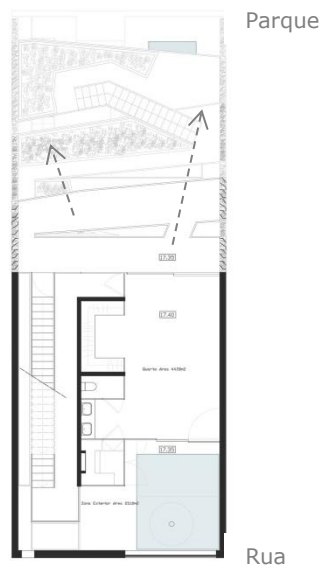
Planta do Piso 3 e Sistema de Vistas
